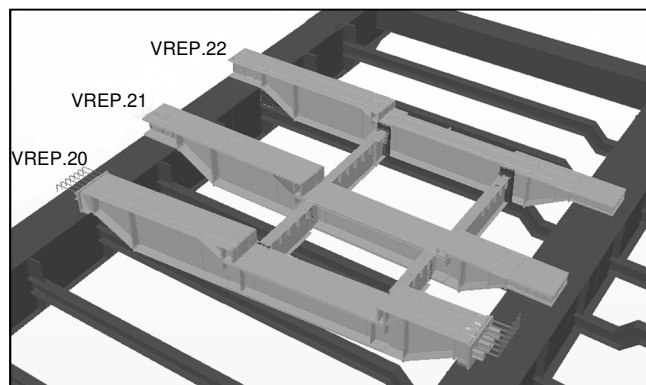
Vigas em estudo com apoio sobre a estrutura pré-existente
